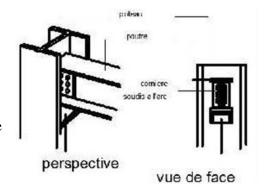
Détail n°02: Assemblage boulonné d'une poutre à l'âme d'un poteau (1/20) Source : auteurs
